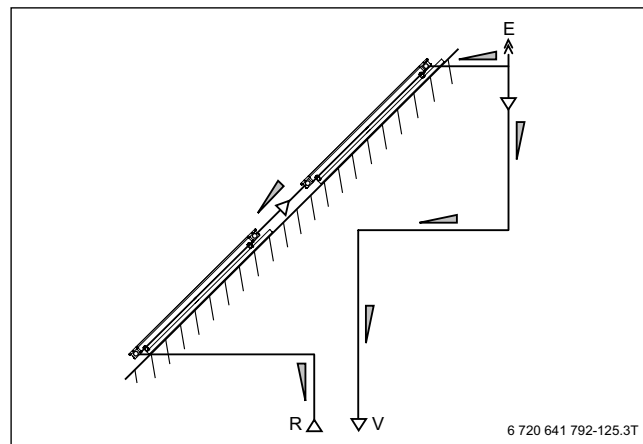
Гидравлическая схема с воздухоотводчиком над верхним рядом на примере монтажа гелиоколлекторов поверх кровли (последовательное соединение)
